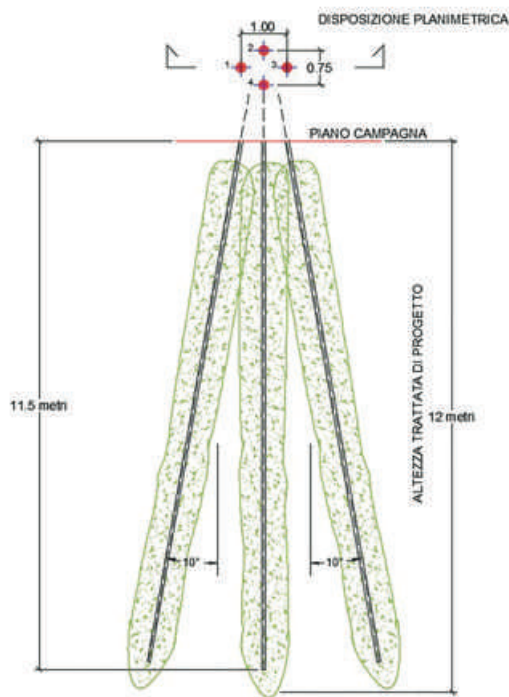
Geometria delle colonne del campo prove (pianta e sezione)
